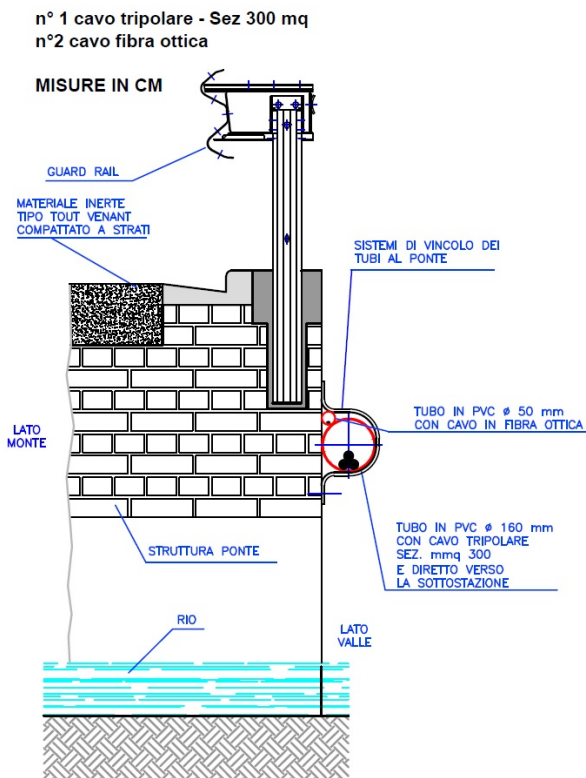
Tipologia di attraversamento su spalletta, punto 7
